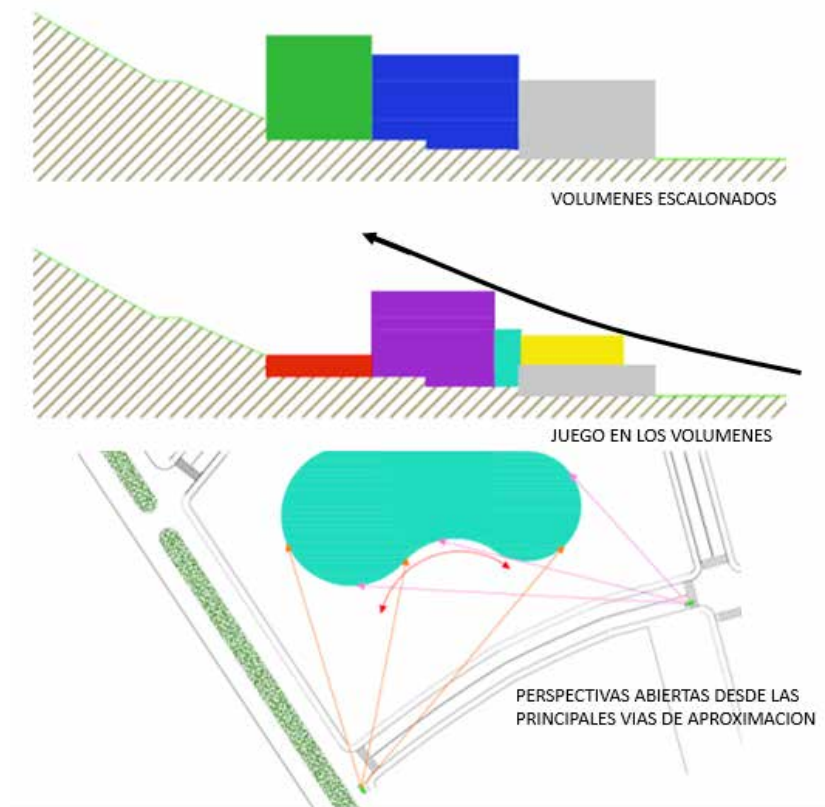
Concepto generador arquitectónico, el Autor, (2018).
